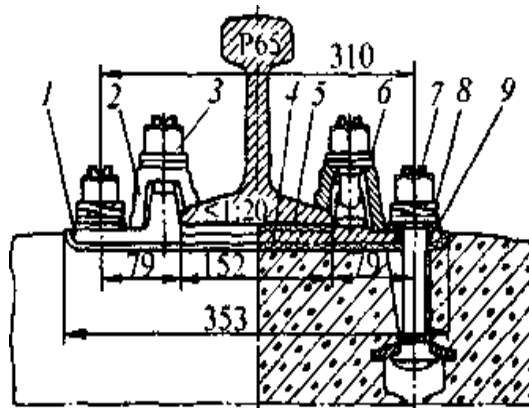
Раздельное клеммно-болтовое крепление для железобетонных шпал:
